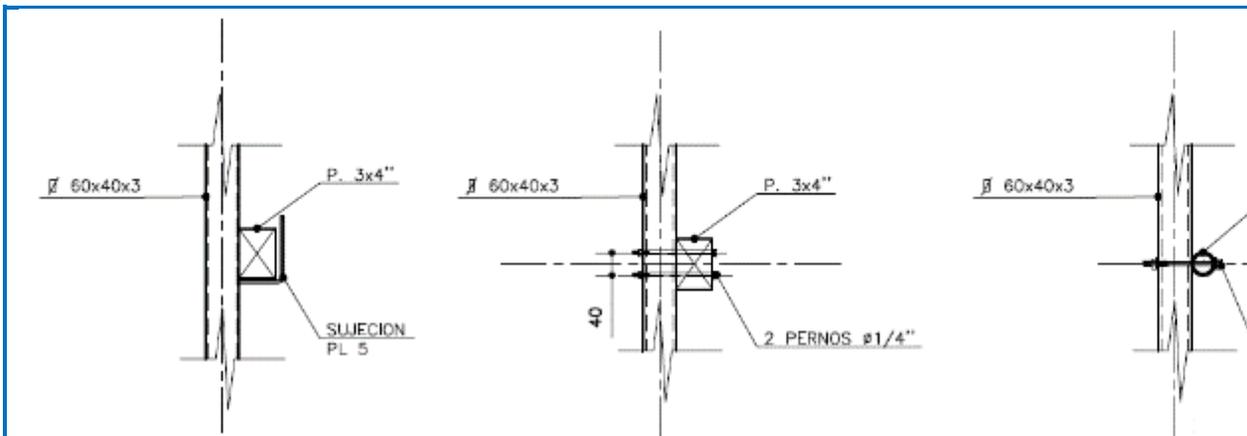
Alternativas de unión entre la placa metálica en L del perfil vertical y larguero horizontal de madera y pernos para los largueros horizontales de madera y para el perfil metálico de pasamano (medidas en cm) - Elaboración propia
